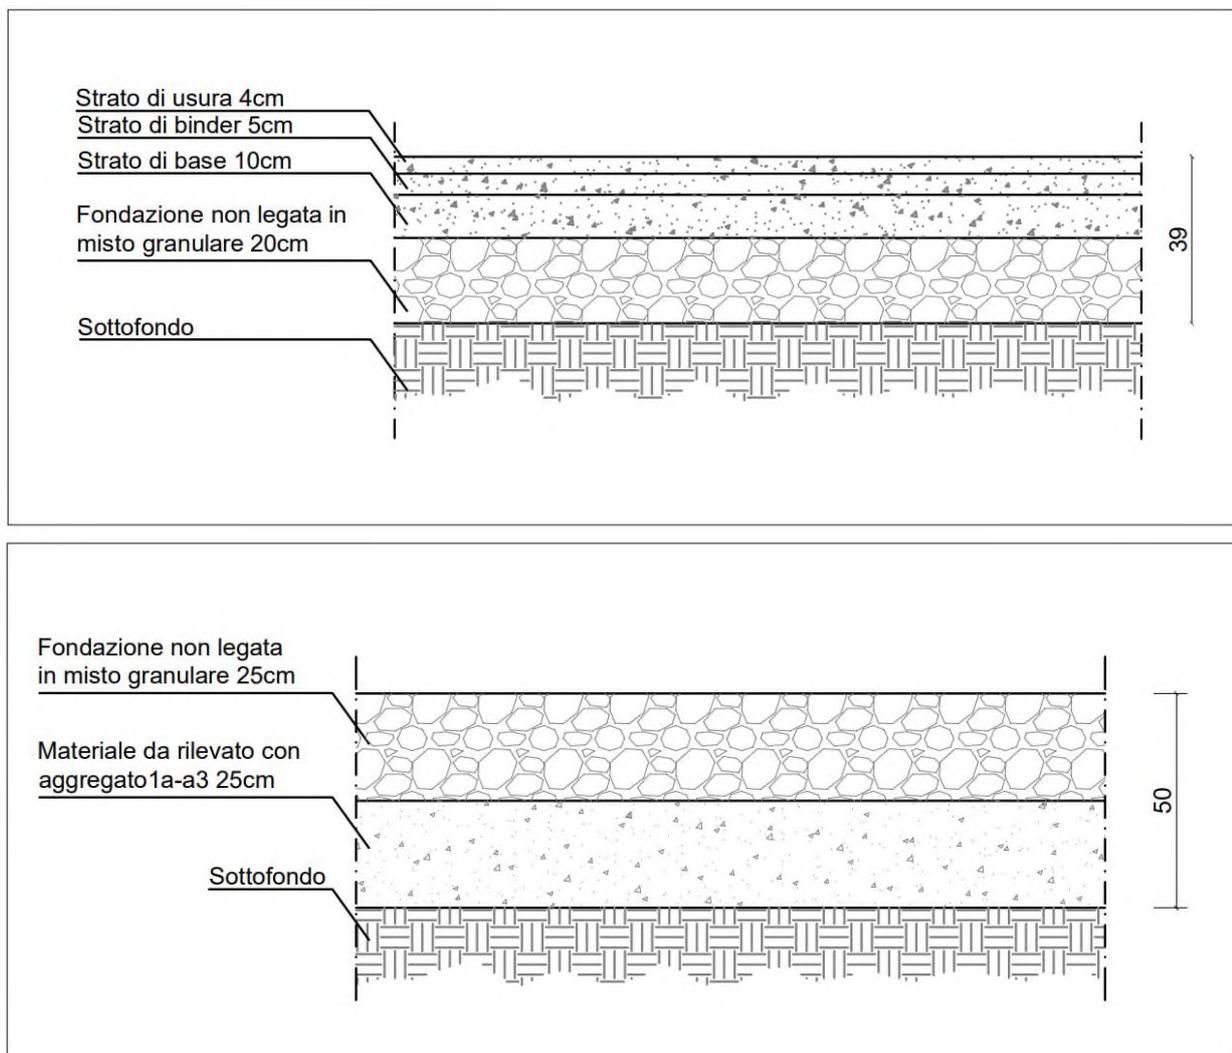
Sezioni tipo dei due pavimentati. Sopra la pavimentazione bituminosa impermeabile; sotto la pavimentazione permeabile in misto granulare
